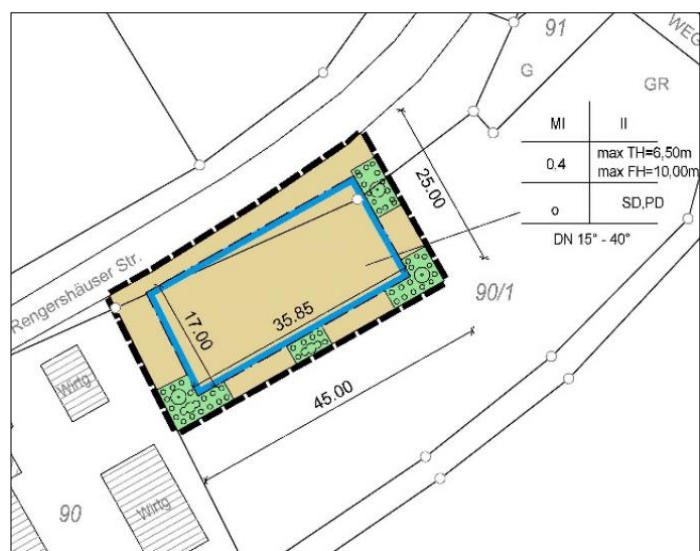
Lageplan (Verfasser: WALTER Ingenieure)
